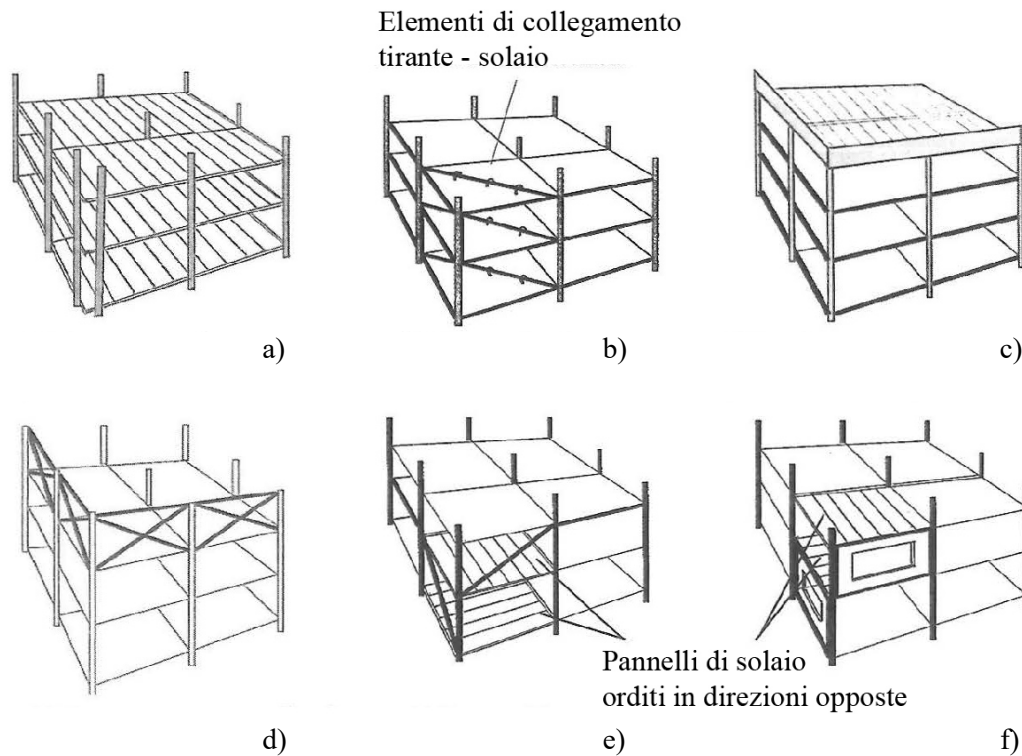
Esempi di soluzioni per aumentare la capacità resistente della zona d’angolo nelle strutture con solai a pannelli prefabbricati: a) doppia colonna d’angolo; b) tirante diagonale; c) trave di bordo rigida; d) struttura reticolare di copertura; e) controvento diagonale; f) pannello di parete, (da fib, 2012)
